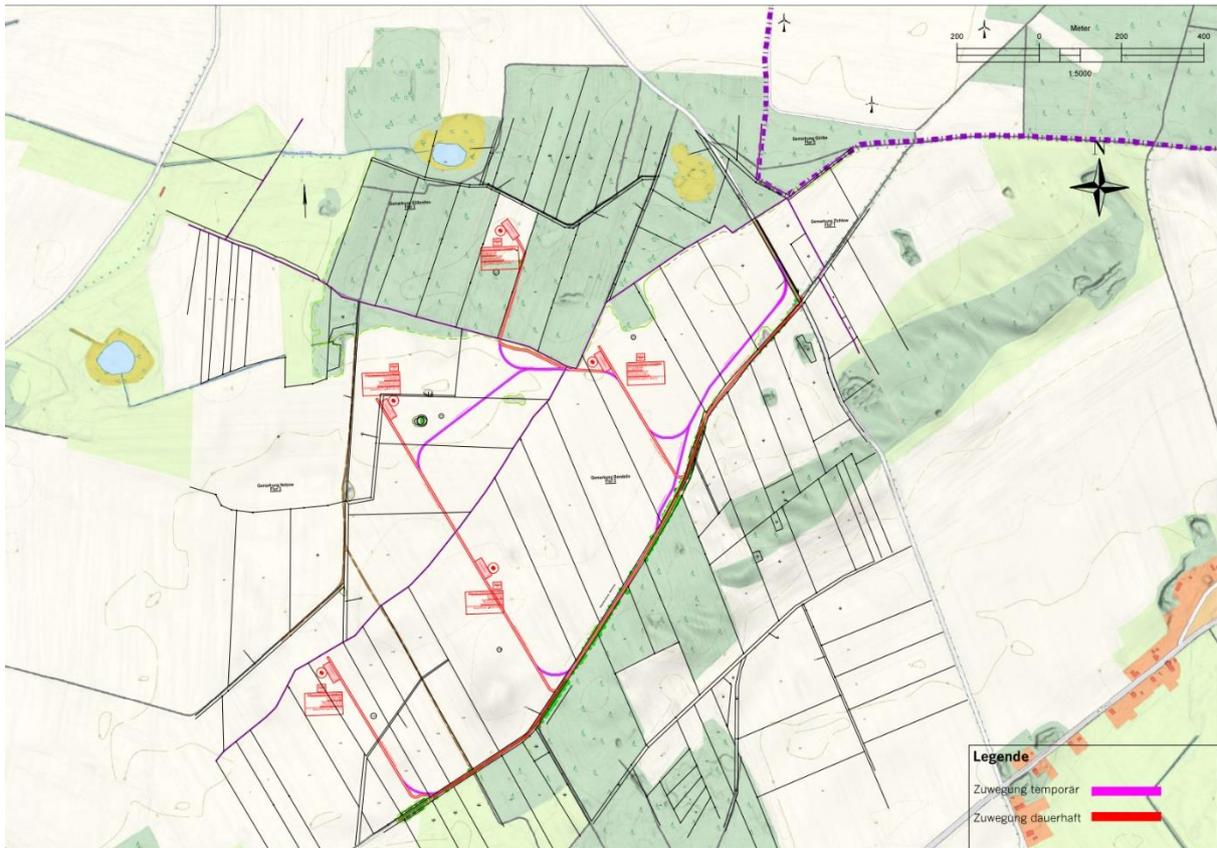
Lage der geplanten WEA im Windpark Zichtow inklusive Kranstellflächen und Zuwegungen
